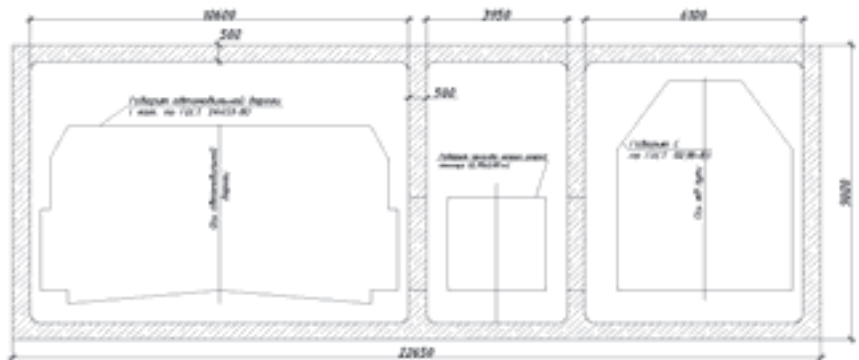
Конструкция тоннелей при открытом способе работ на пойменных участках
